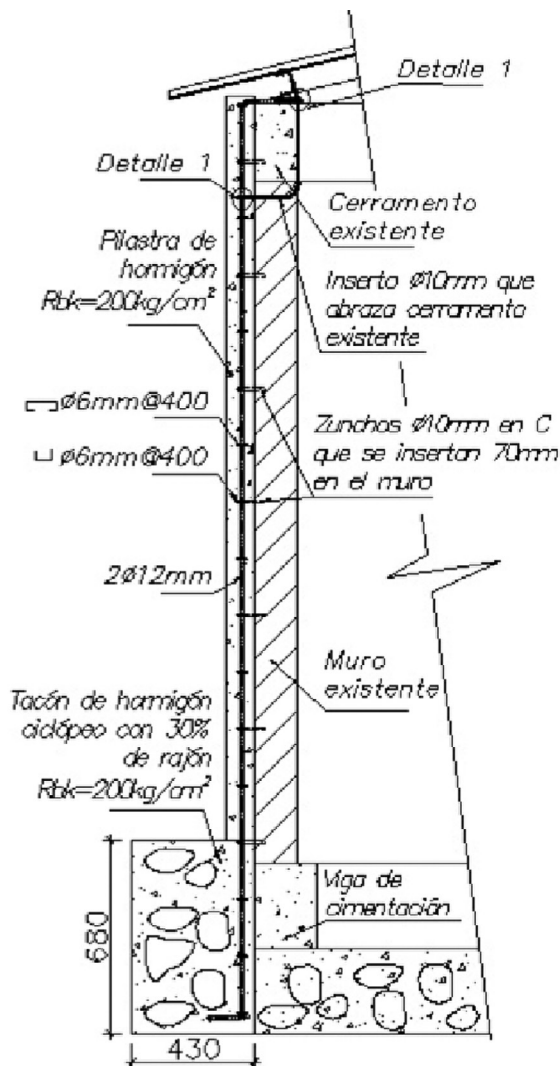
VISTA EN CORTE DE PILASTRA ADOSADA A INTERSECCIÓN DE MURO, CON DETALLE DE UNIÓN A VIGA DE CERRAMIENTO.
